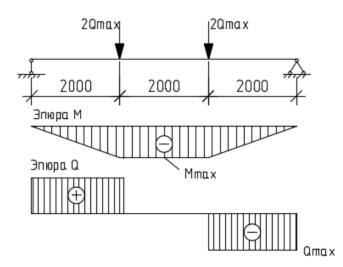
Расчетная схема ригеля перекрытия
